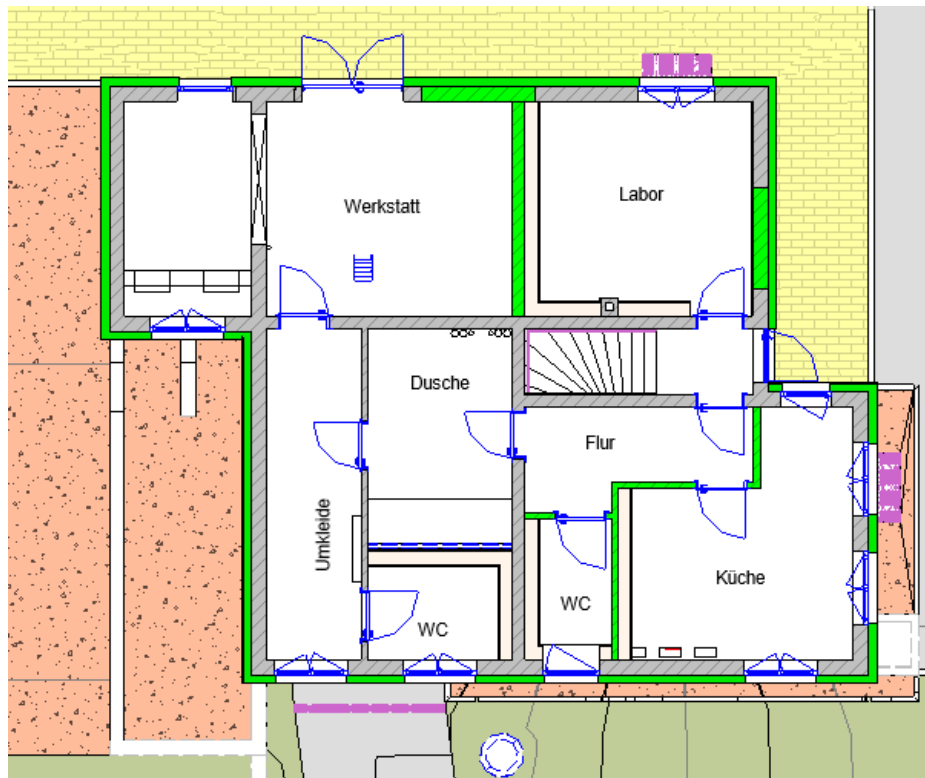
Grundriss Betriebsgebäude EG
